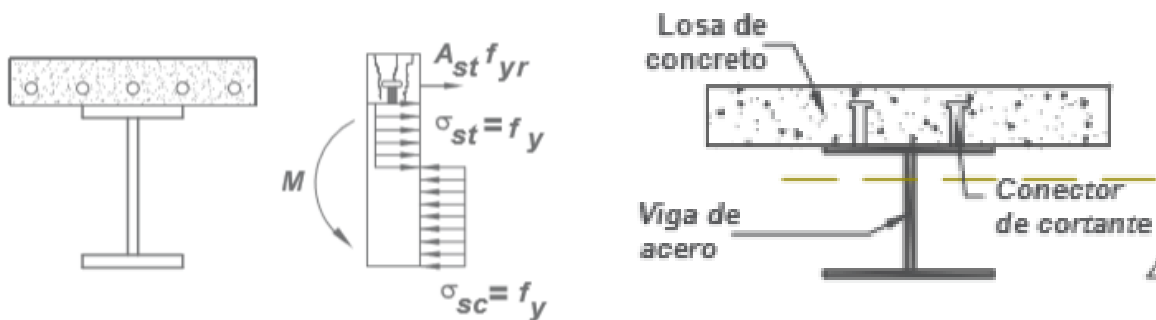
Conectores a Cortante. FUENTE : Construcción Compuesta
